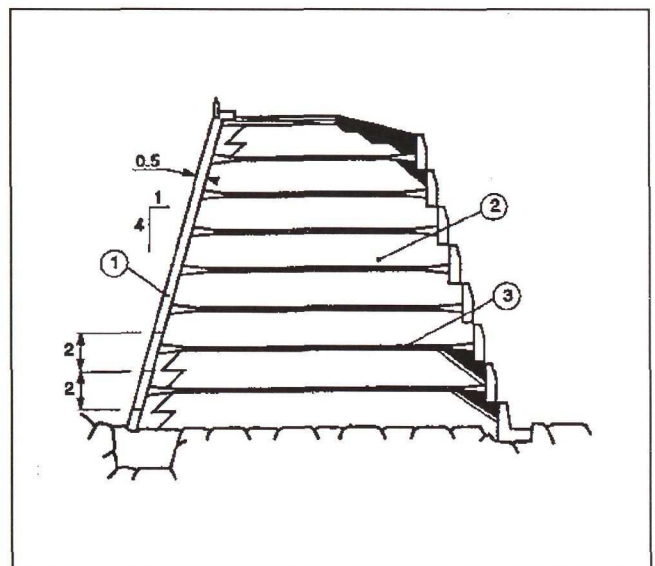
Coupe du barrage Conqueyrac (France) hauteur 21 m, 1982 barrage déversant en enrochement renforcé avec parement amont; 1 : parement étanche amont ; 2 : enrochement renforcé ; 3 : armatures "TOR" recouvertes de béton.
